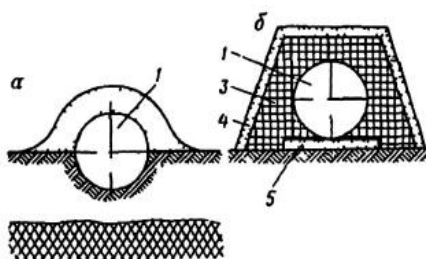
Схема прокладки трубопроводу з частковим заглибленням на болоті (а) і в шарі мінерального ґрунту (б): 1 – трубопровід; 2 – обвалування торфом; 3 – обвалування мінеральним ґрунтом; 4 – шар мінерального ґрунту; 5 – скельний ґрунт
